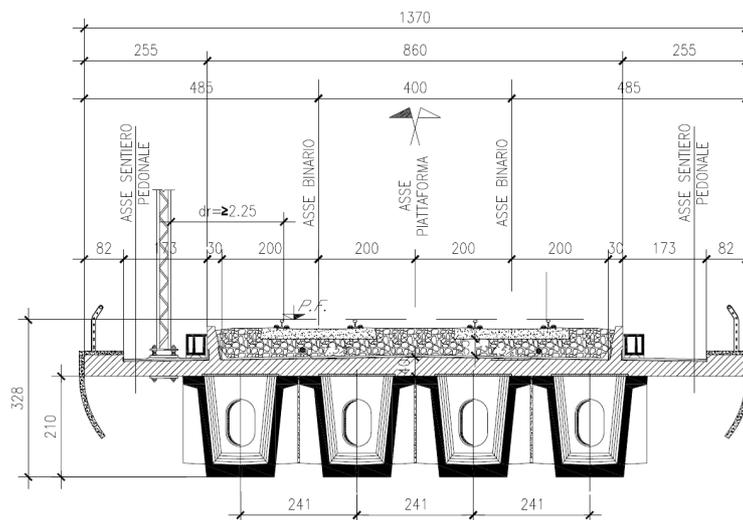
impalcato in c.a.p.: sezione trasversale
